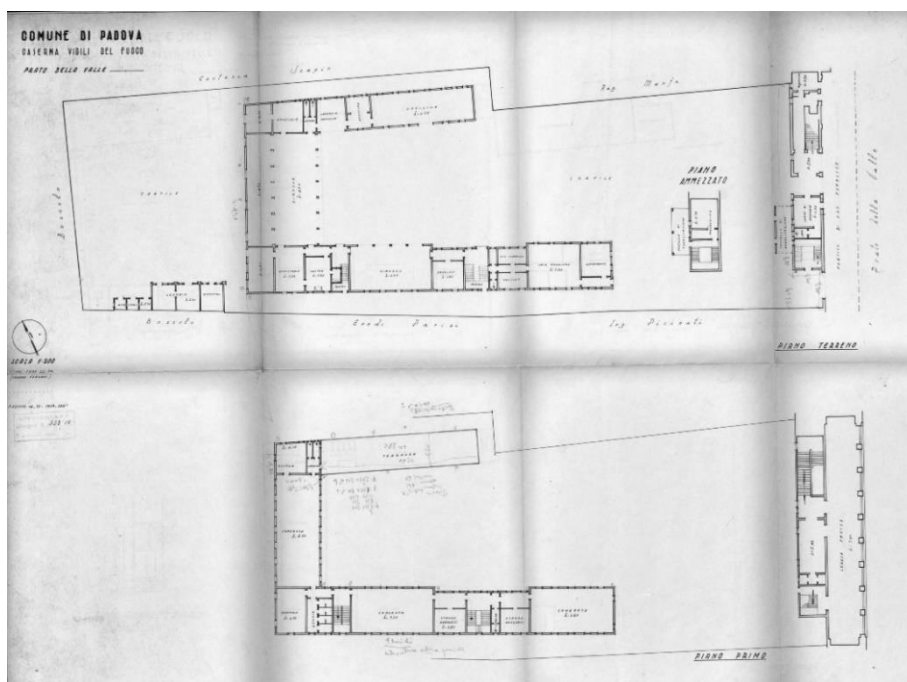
Pianta piano terra e piano primo, 1939 [AGCPd].
